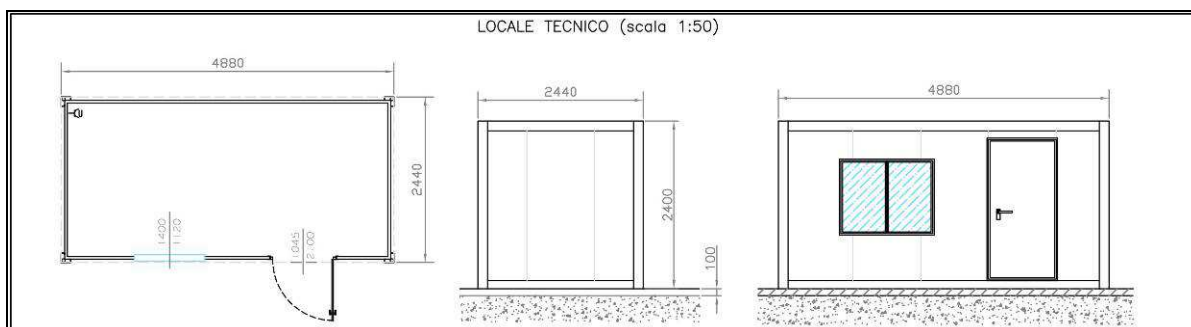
Pianta e prospetti tipo della cabina di ricezione Enel
